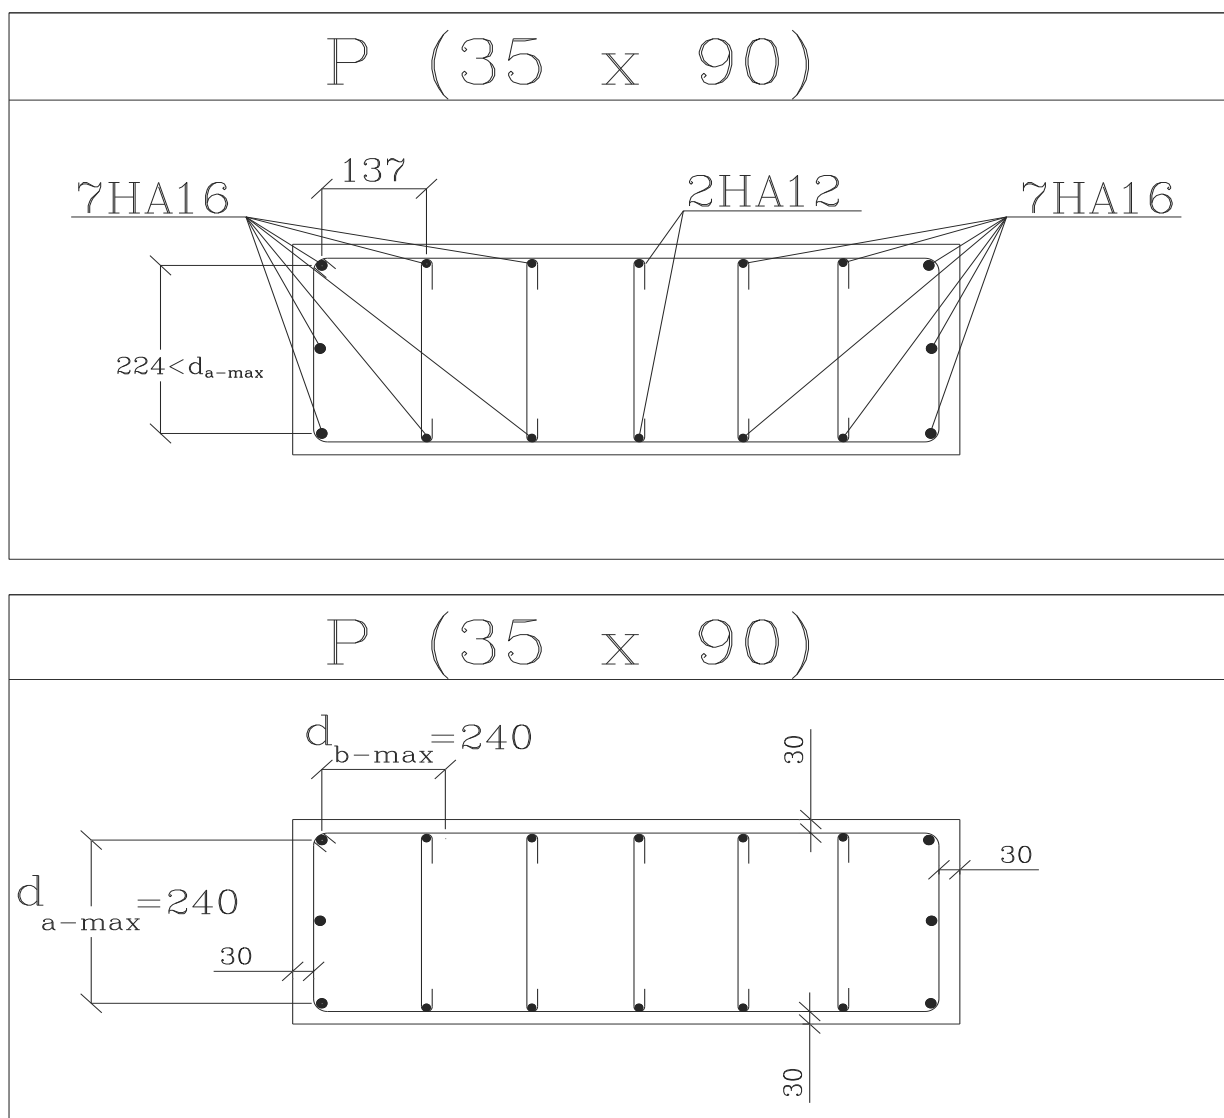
Schéma de ferrailage du poteau 35x90 à l'état maximal (Exemple 2)
